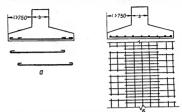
148. Армирование плиты ленточного фундамента при вылете свесов полож более 750 мм: а — отдельным стержиния: 6 — сверным сетками.
